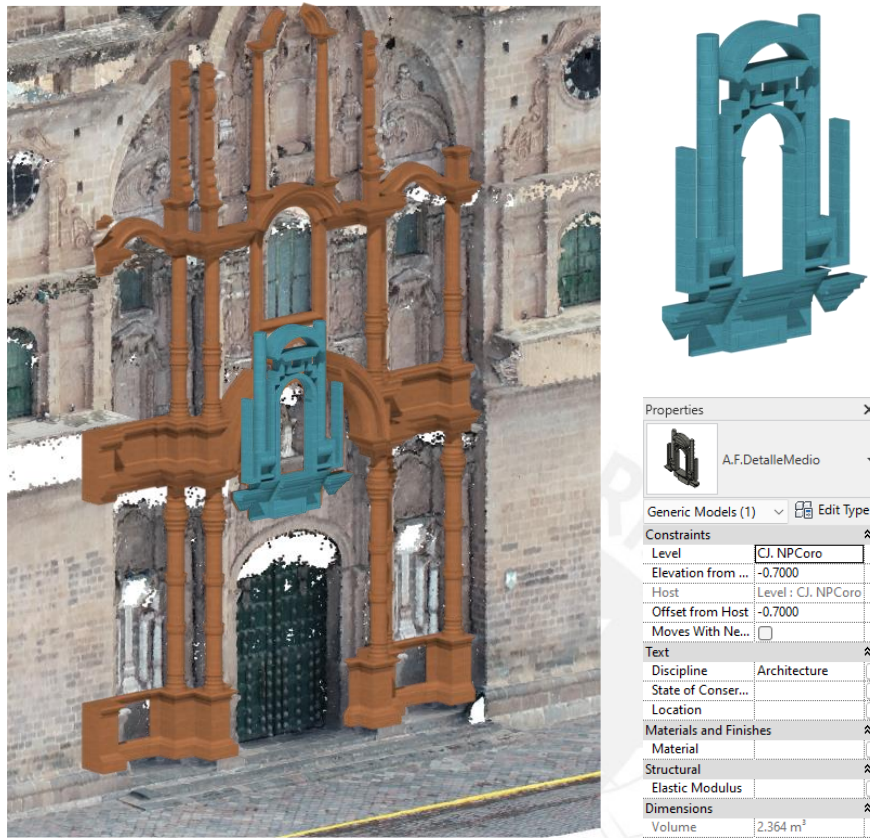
Elemento arquitectónico de la fachada modelado como elemento *In-place
